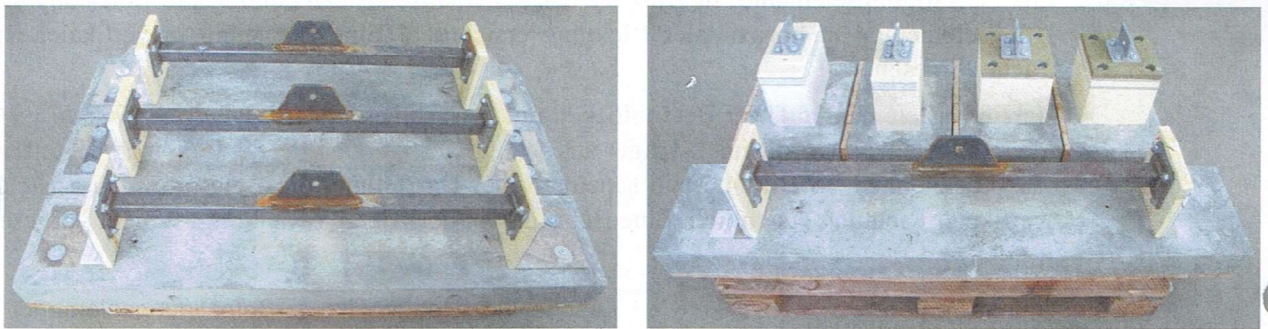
Prüfkörper befestigt auf Betonblöcken [Empa-Nr.: 5214007962/05]
